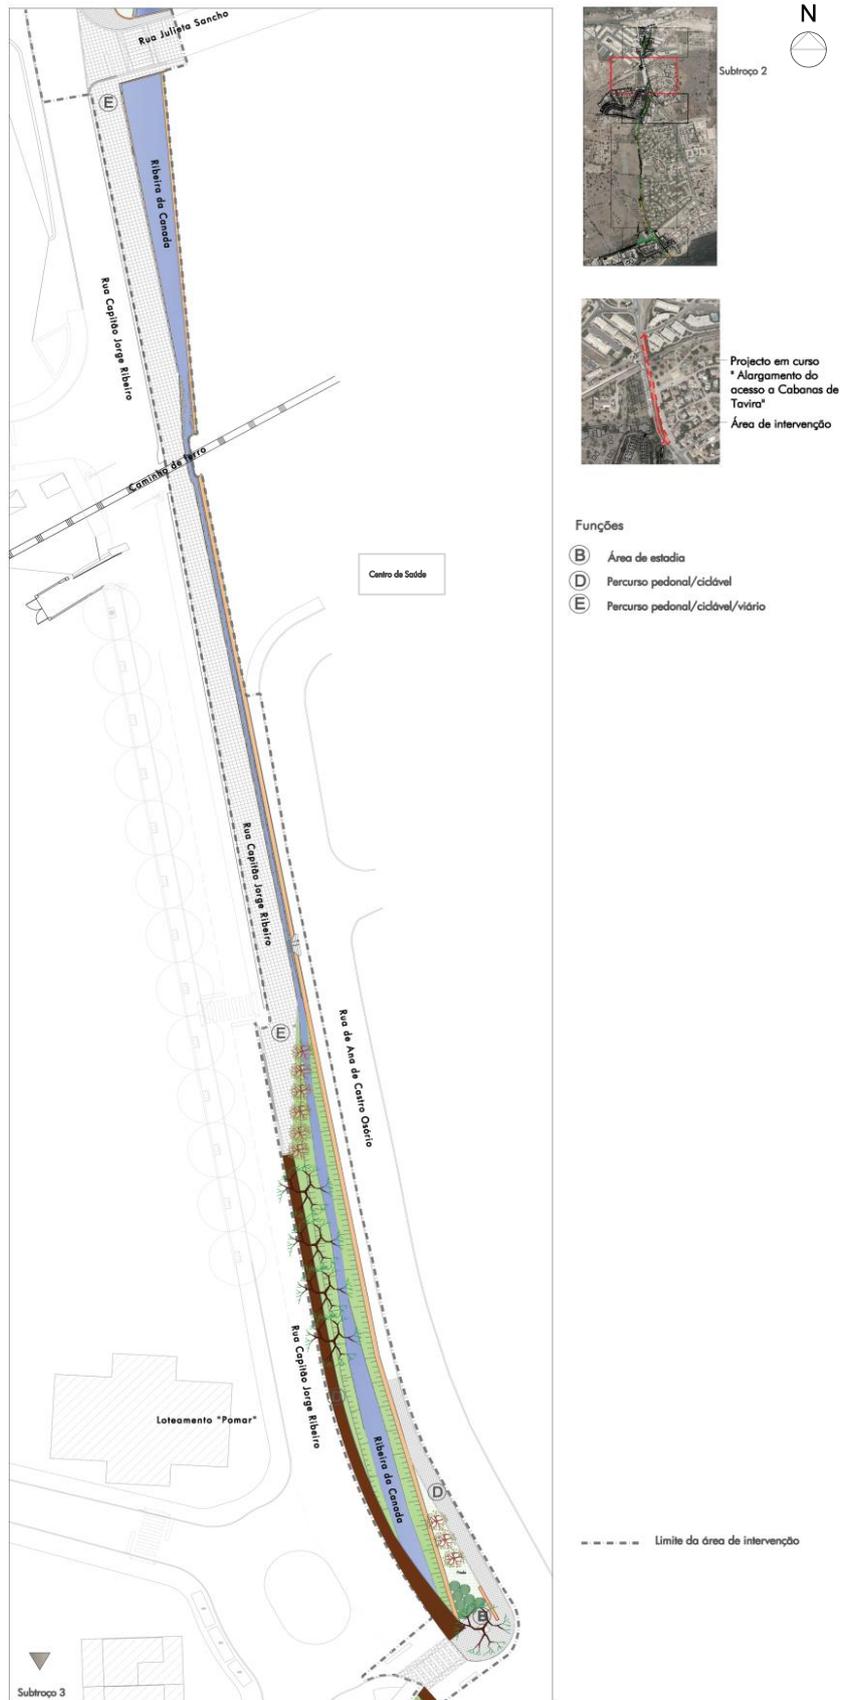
Plano Geral - Subtroço 2; Vânia Rodrigues
